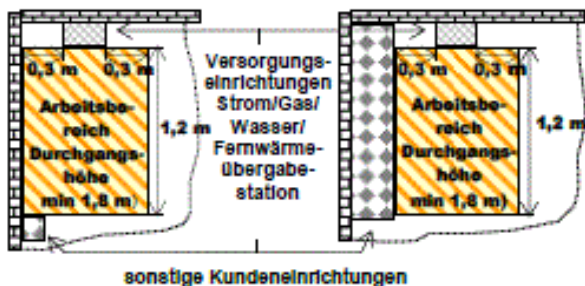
Gemeinsame Hausanschlussstrasse auf dem Privatgrundstück (Maßangabe in mm)
